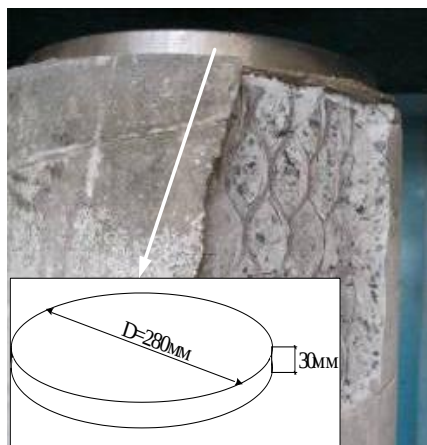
Додаткові пристрої для передачі зовнішнього навантаження тільки на бетонне ядро сталобетонного зразка
